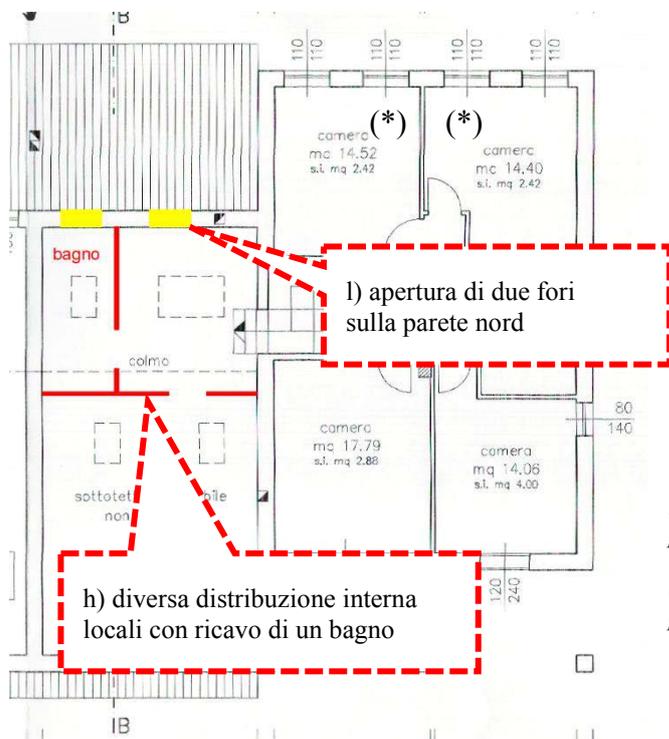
Estratto planimetria piano primo con indicazione delle difformità (*) locali nei quali non è stato possibile accedere
